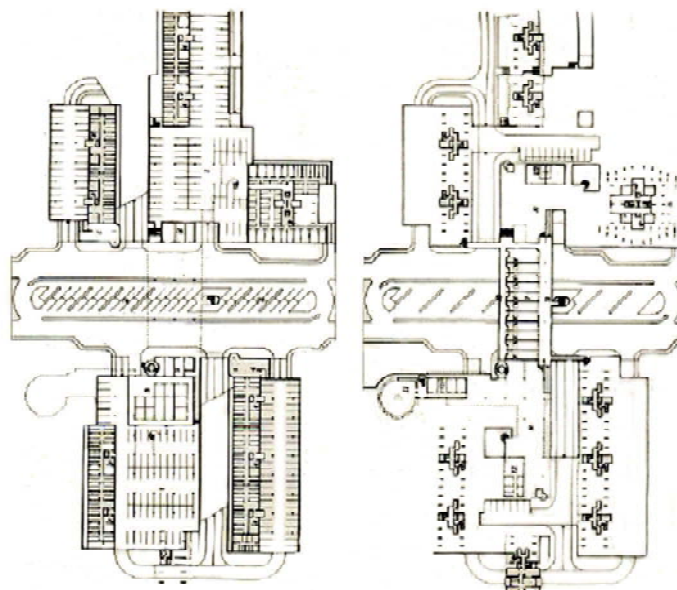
Pianta garage e pianta piano tipo di un'unità di abitazione
